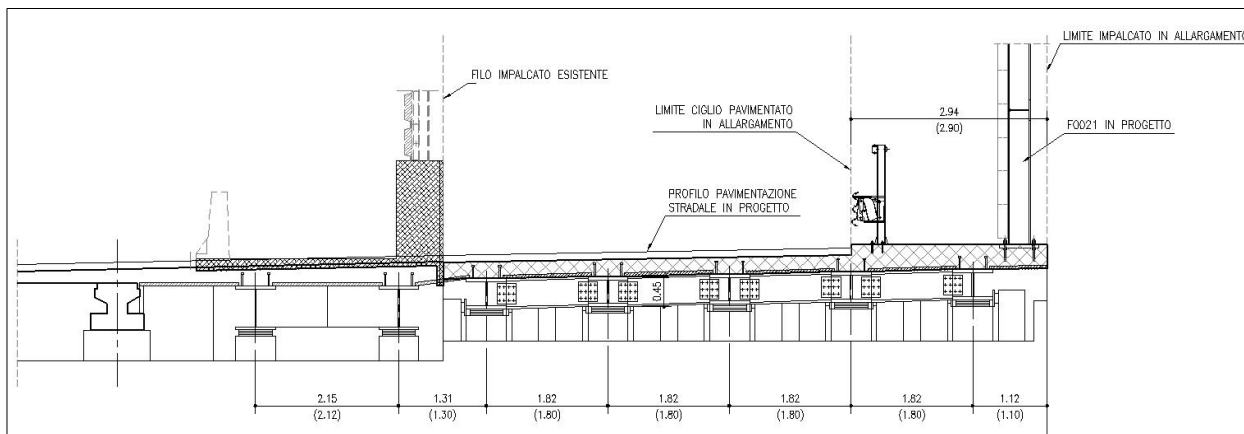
Sezione trasversale ampliamento – Lato Nord
